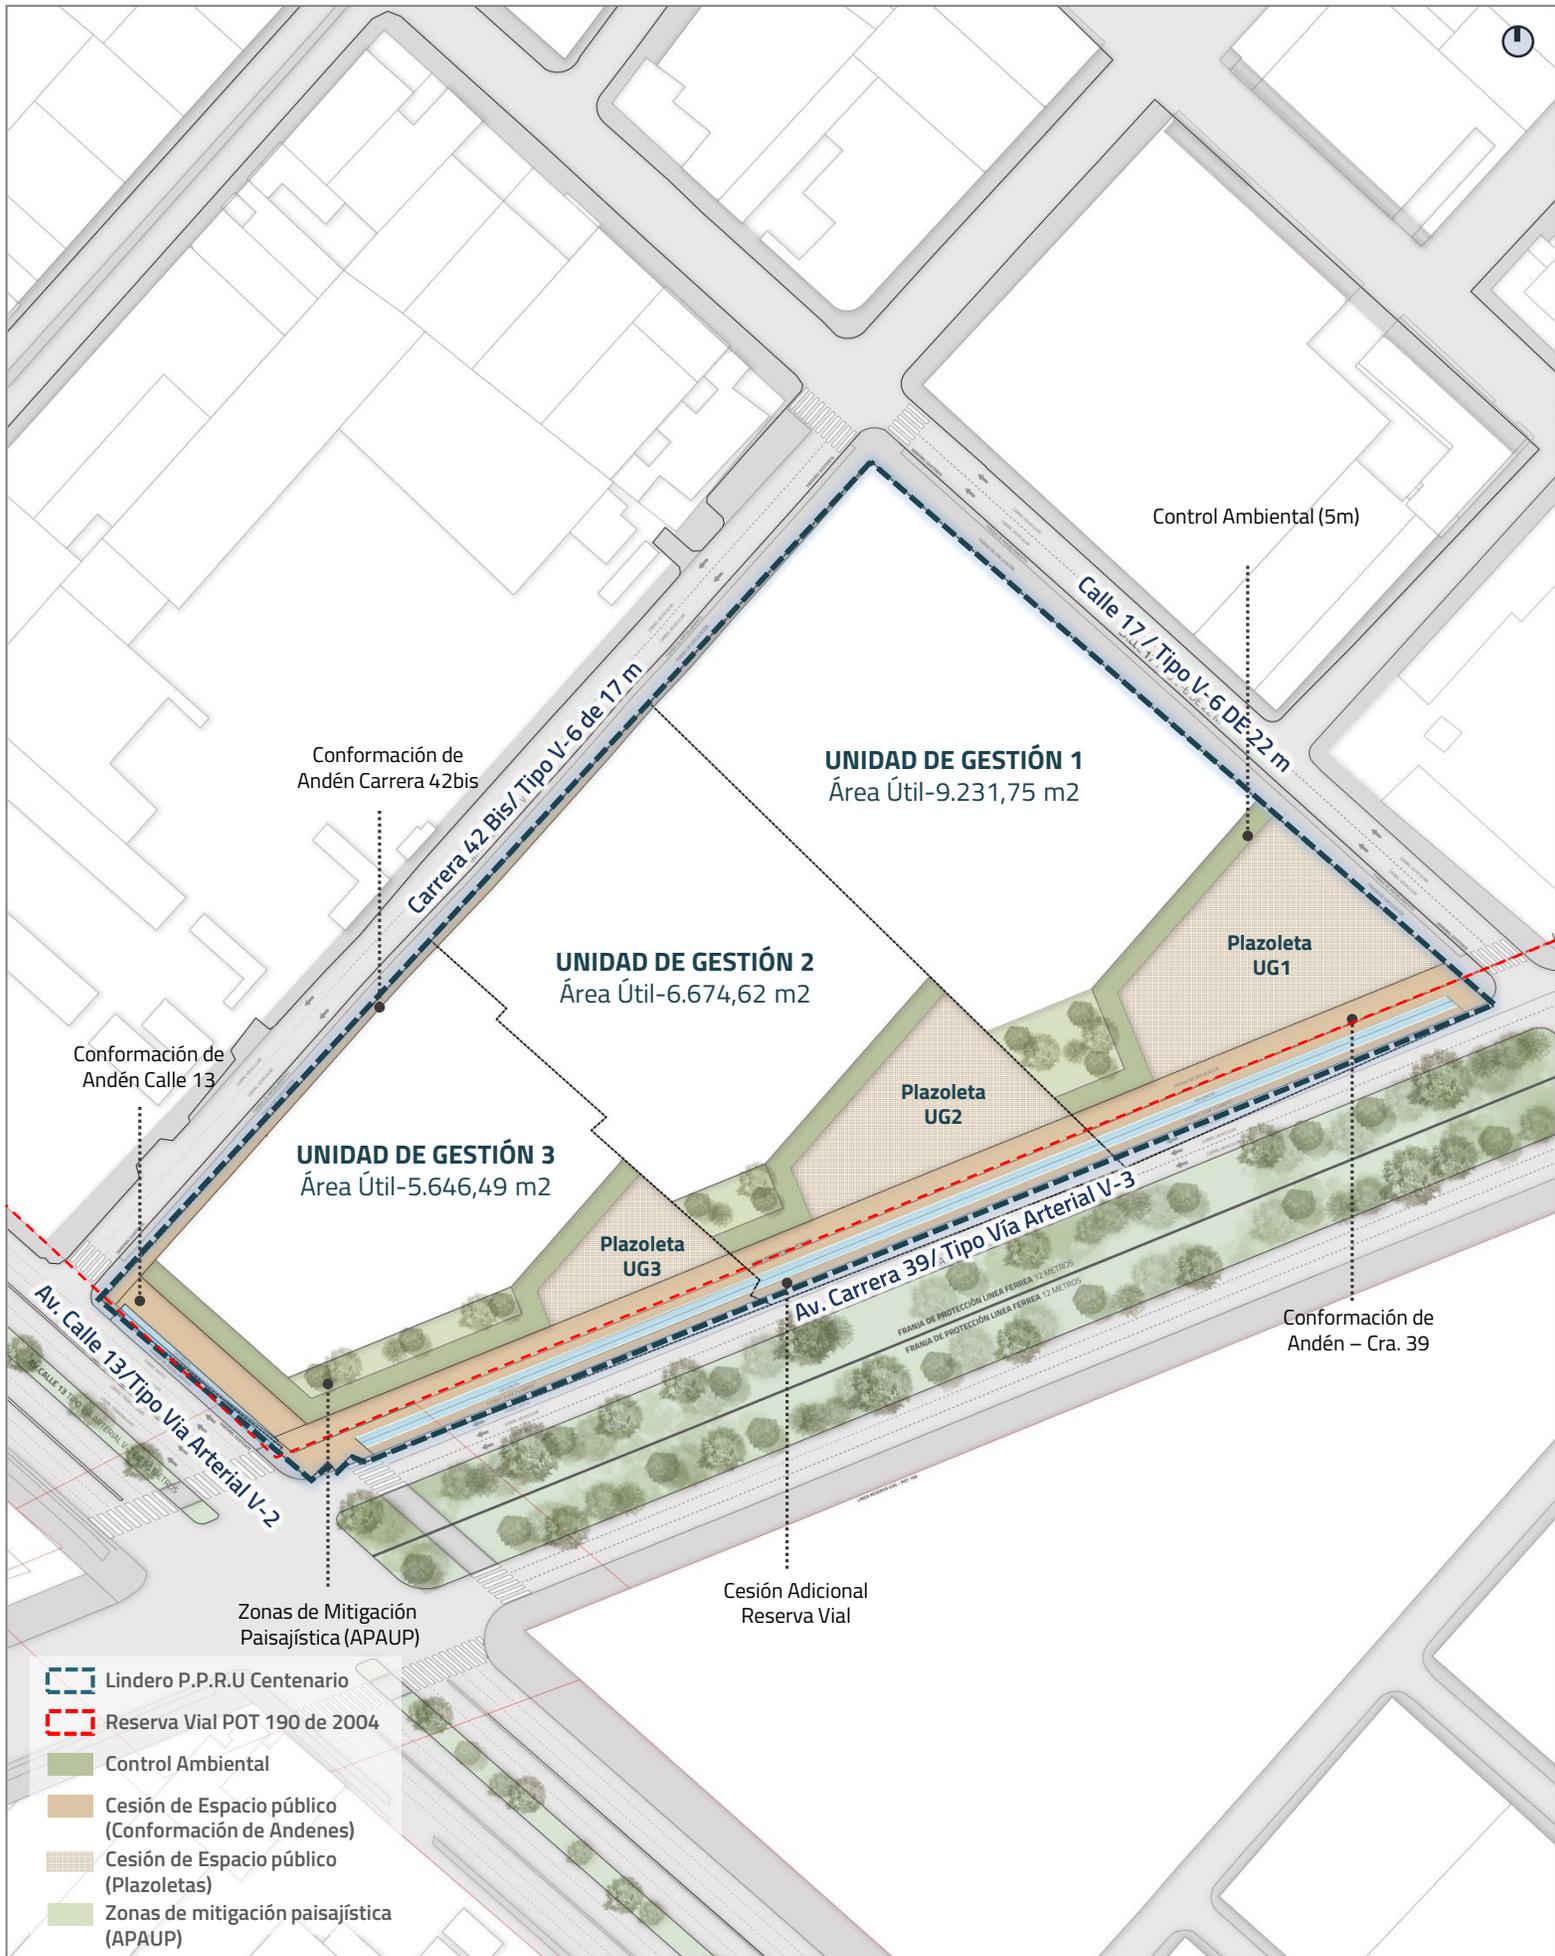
Plano Urbanístico General PPRU Centenario Fuente: Elaboración Propia
